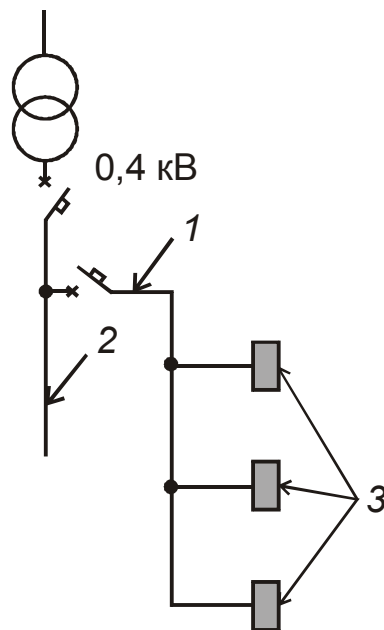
Схема питания сети освещения от шинопровода: 1 – питающая сеть; 2 – шинопровод; 3 – групповые щитки рабочего освещения
